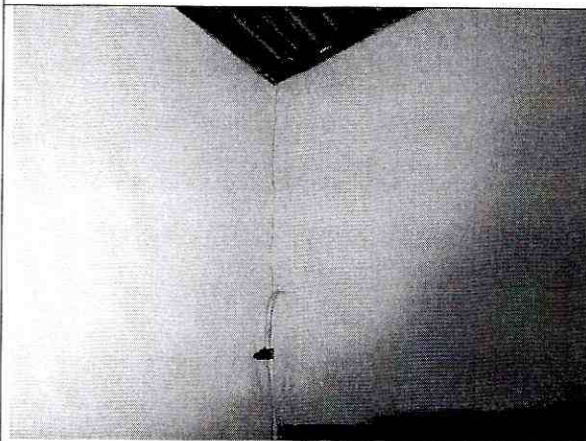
Fisuras en muros del costado norte, segundo piso.
